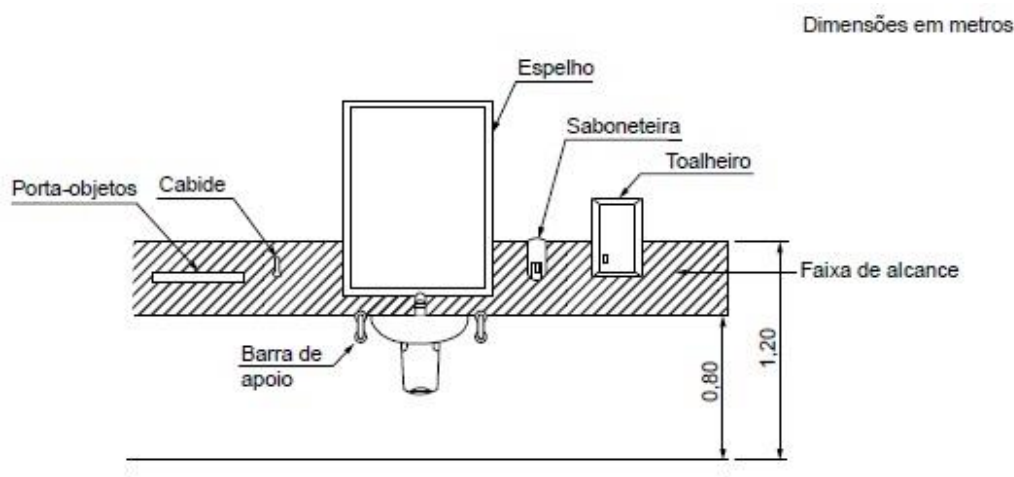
Faixa de alcance de acessórios junto ao lavatório – Vista frontal
